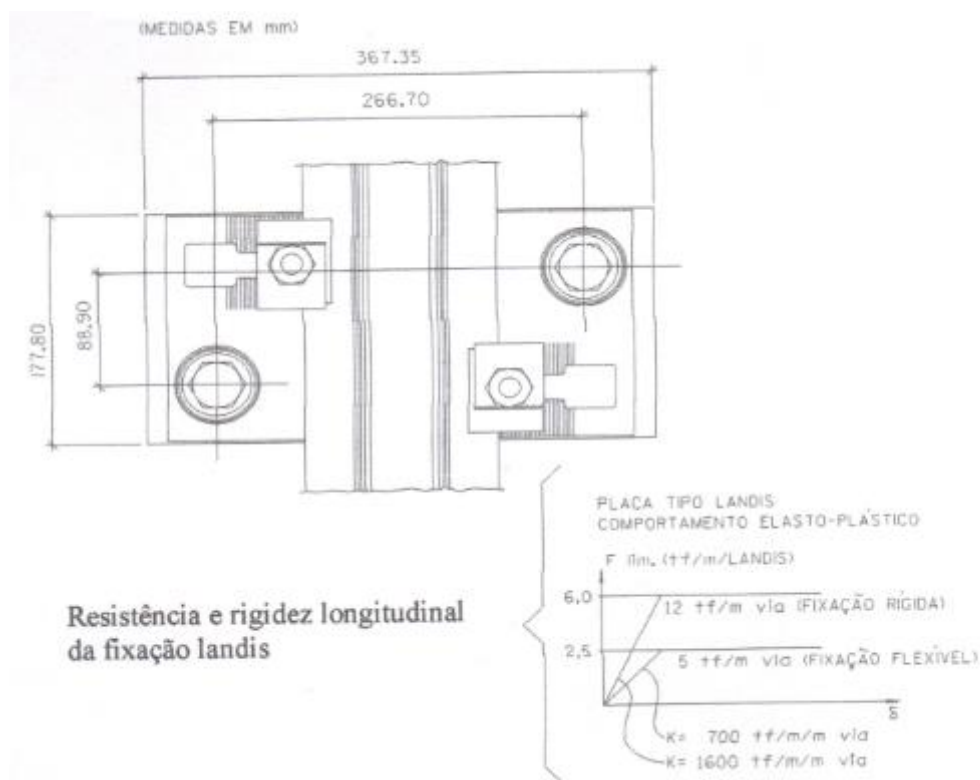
Fixação Landis em Planta – Fonte: [MAUBERTEC, 1996]
